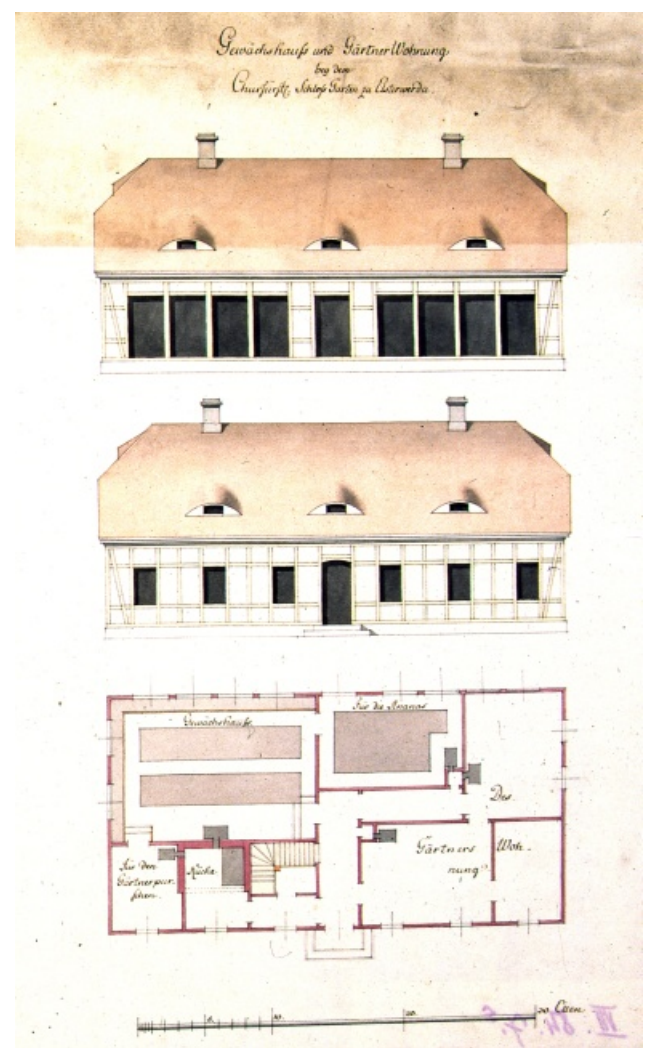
Aufrisse und Grundriss des Gärtnerhauses in Elsterwerda, SächsHStA, 12884 - Karten und Risse, Schr 007, F 084, Nr 007c
